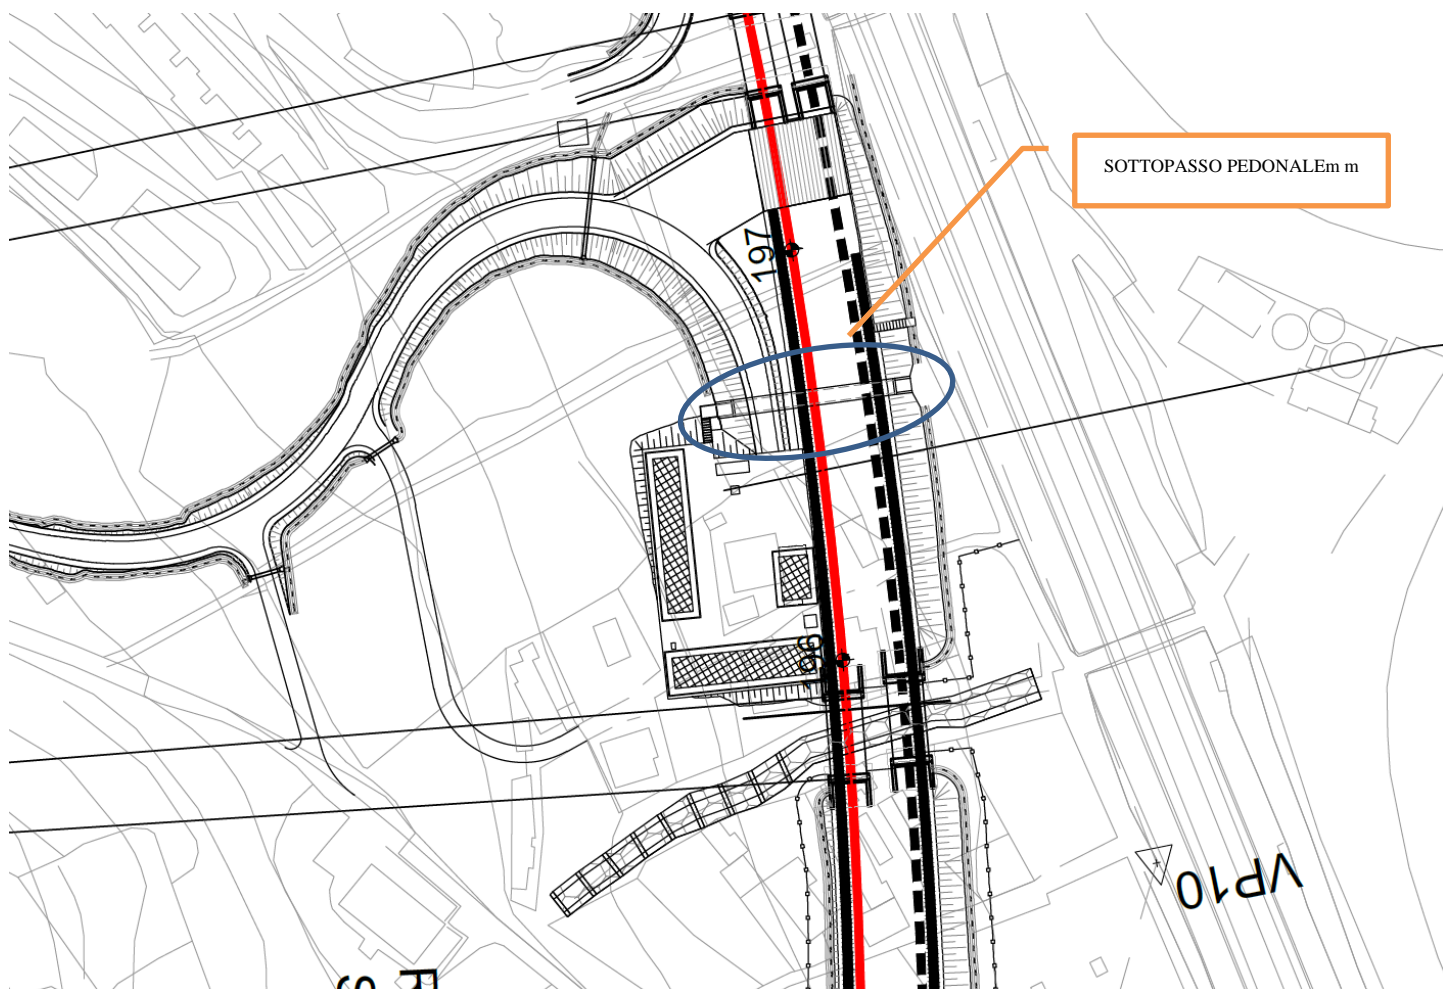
Planimetria d'inquadramento Sottopasso pedonale
